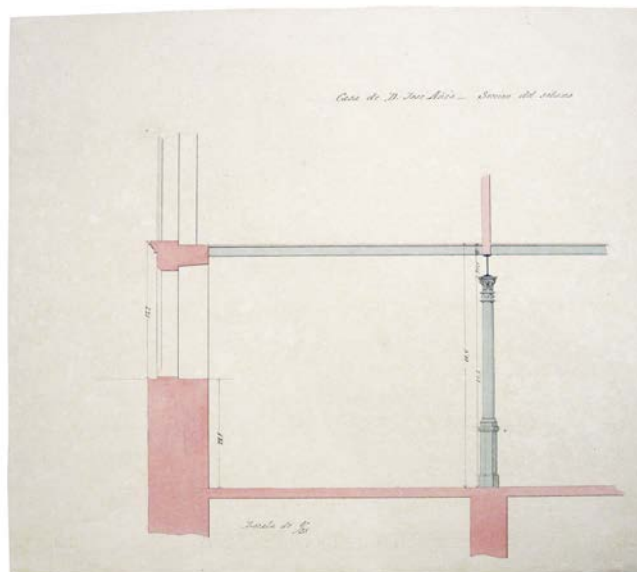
Plànol de secció de planta soterrani (casa Josep Añés, arquitectes Bassegoda, 1881). Font: AHCOAC H121D/7/501.
